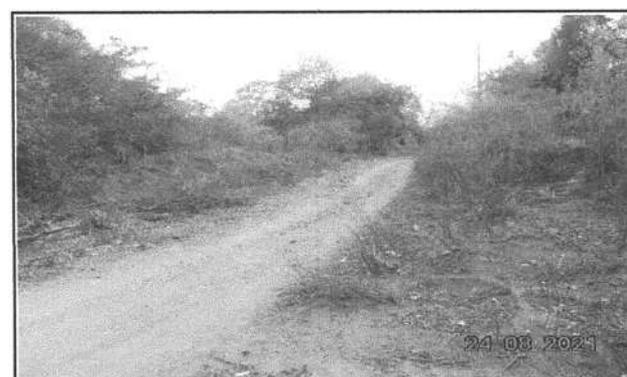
LOCAL DA CONSTRUÇÃO-BUEIRO
